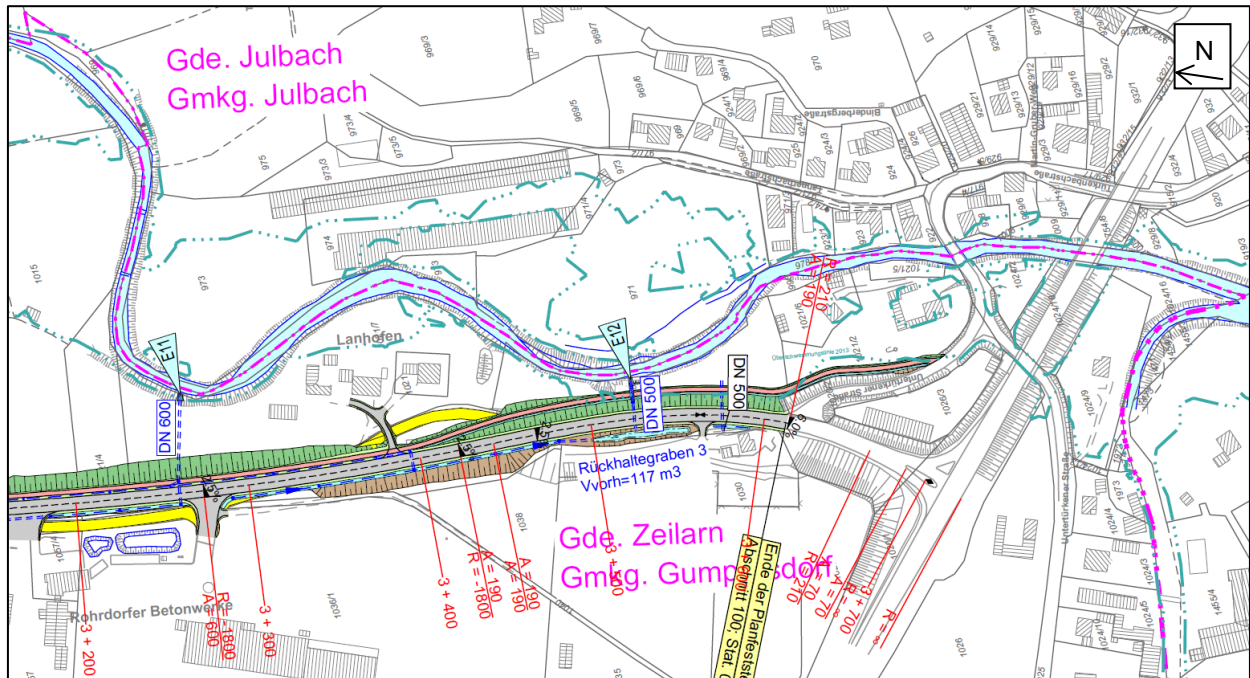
Auszug Lageplan 2, Abschnitt Untertürken (StBA Passau, 2020b)
